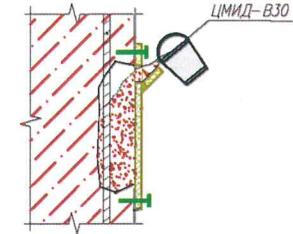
Ремонт участков с поверхностными дефектами бетона глубиной от 1 до 5 см и площадью до 1 м² с обнажением арматуры.
